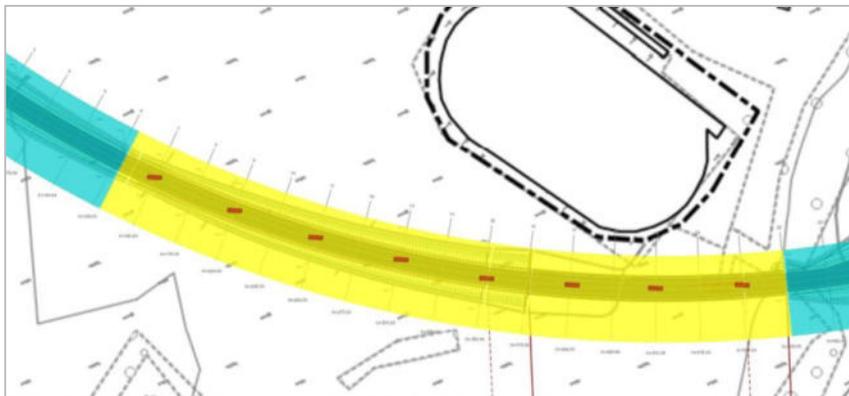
Estratto dalla Planimetria con l'ubicazione delle indagini (Area 1a).
